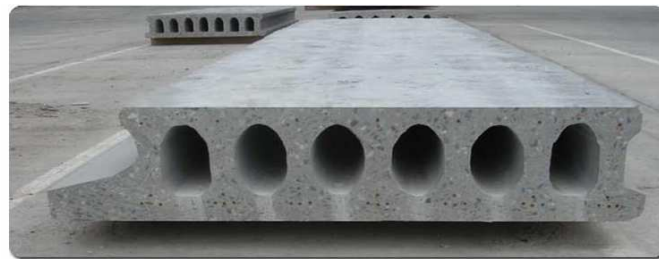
Placa cortafuegos prefabricada de hormigón
